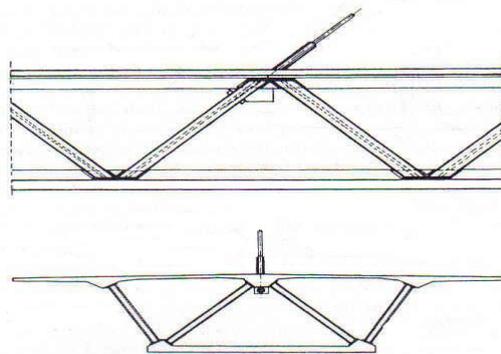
Tablero mixto acero-hormigón tipo cajón
